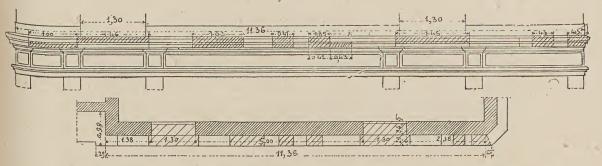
et 198. — Elévation et plan du balcon du 3° étage. — Restauration en ciment métallique et silicate deux couches, ton gris.
